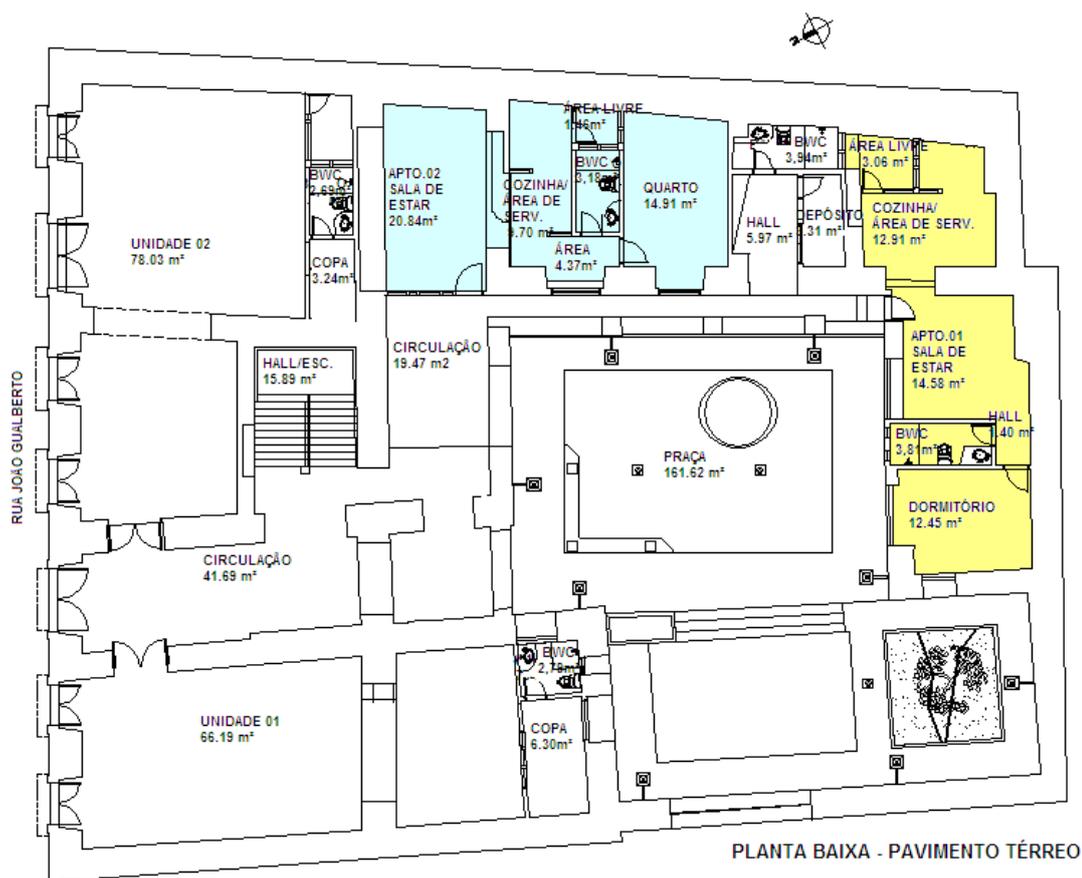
Ilustração de Planta Baixa de Primeiro Térreo.
